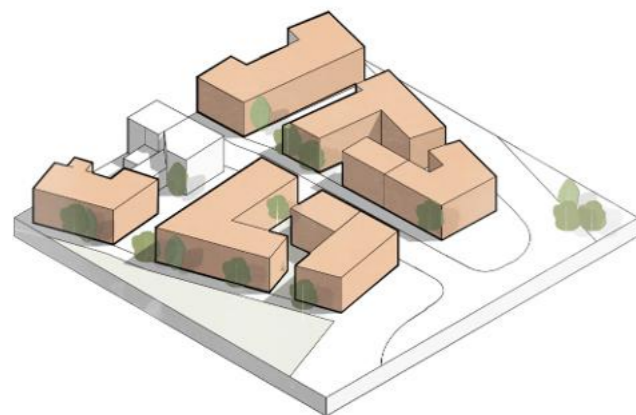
Ergänzender Neubau - Beispiel: Kernstadt, Hotel Eilers
